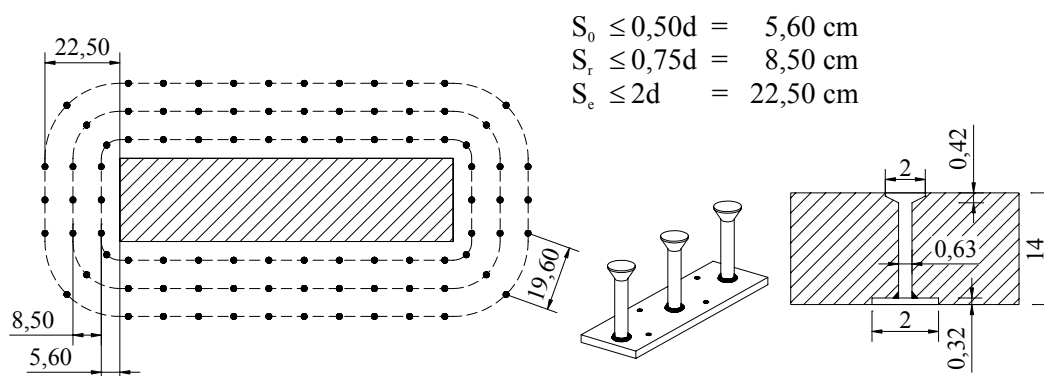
26 Detalhamento da armadura de punção no pilar P11
